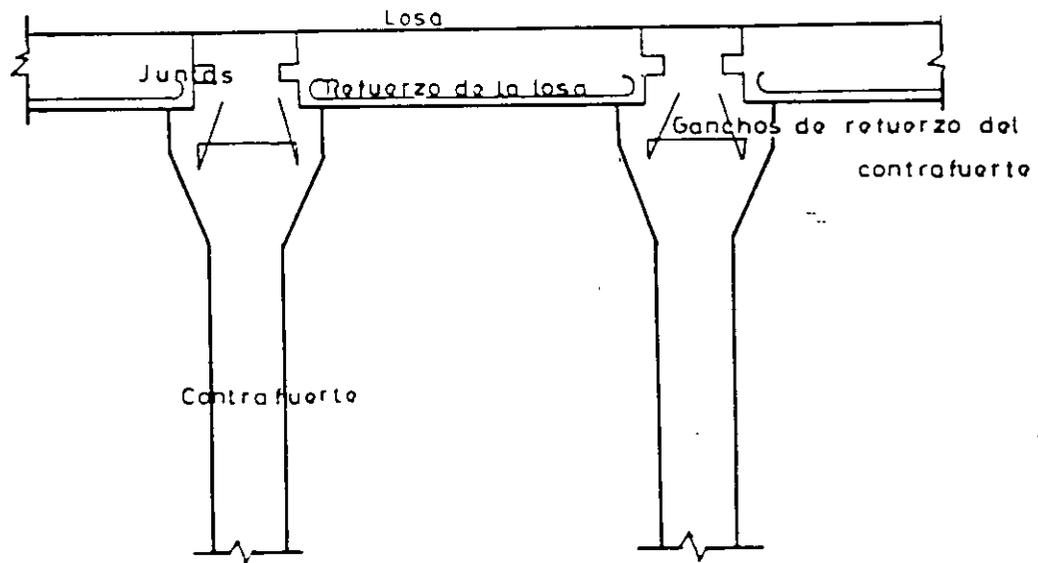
Sistema de juntas entre la losa y el contrafuerte.
